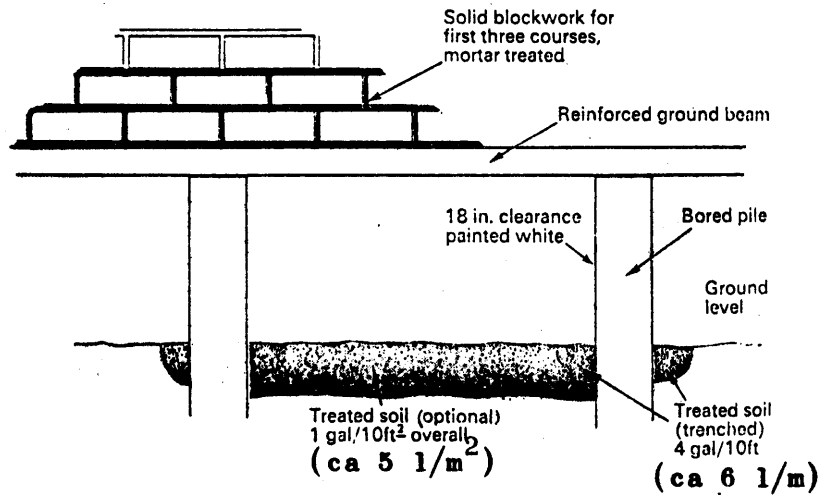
Markbehandling vid kryprumsgrundläggning med bärande betongpelare och balkar
